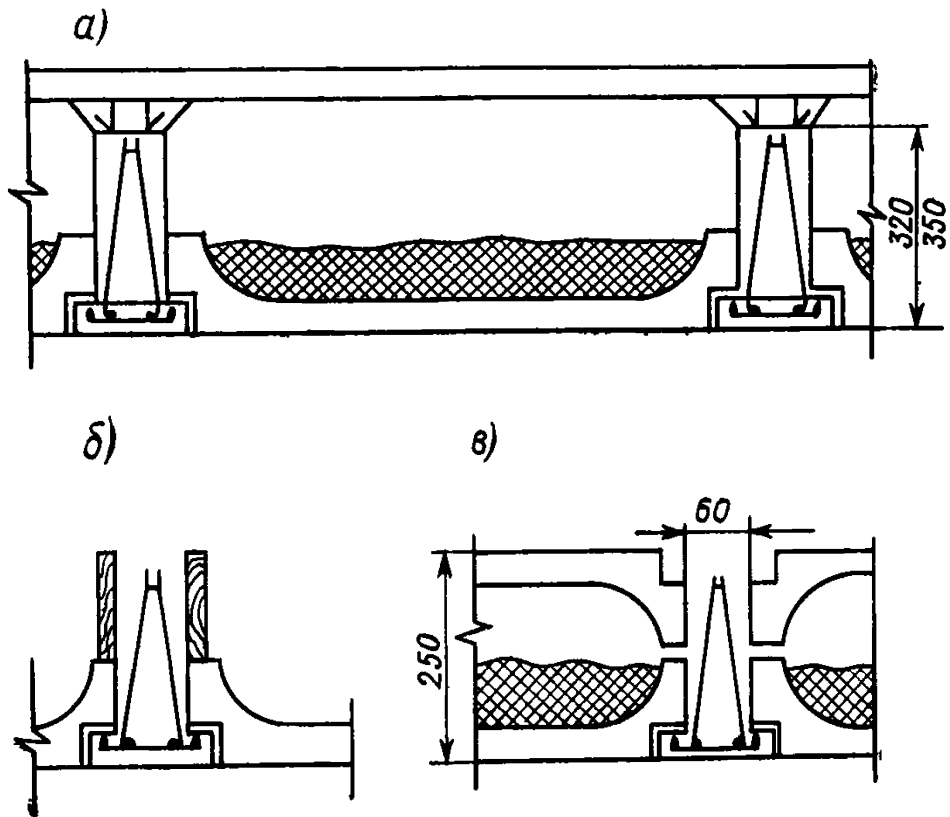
Сборно-монокрипное перекрытие конструкции Ростовского НИИ АКХ
